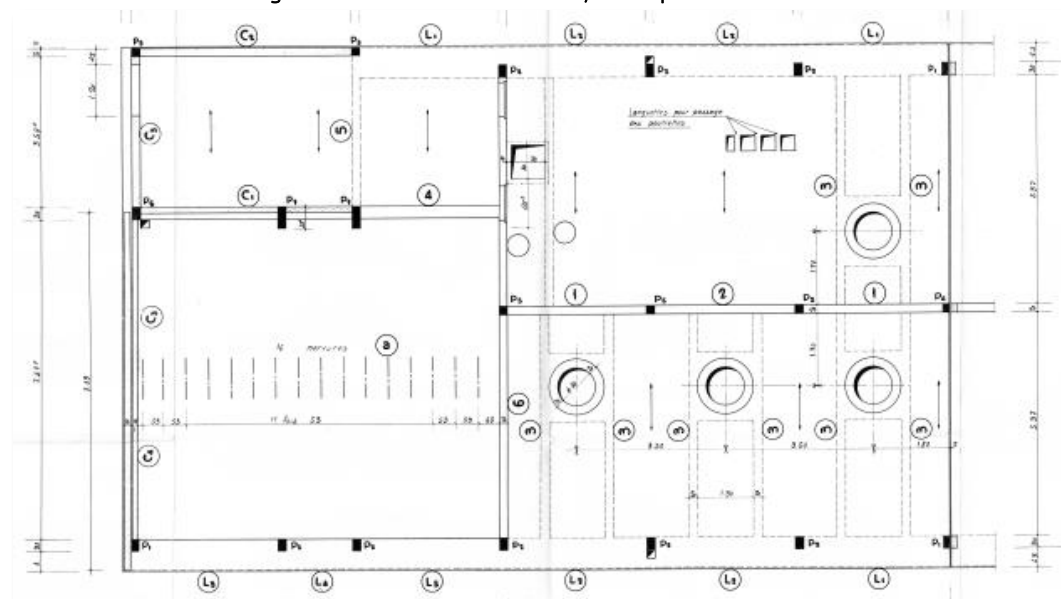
Vue en plan terrasse bloc 4, extrait BA137
